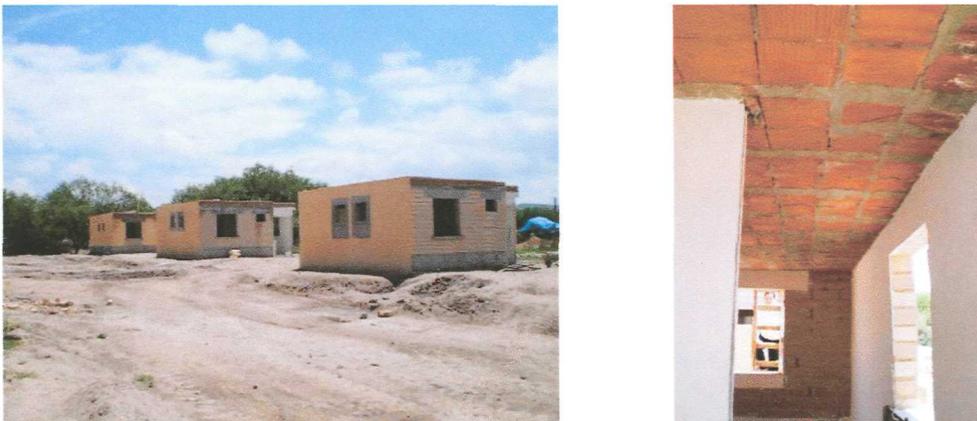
Viviendas en construcción en Doctor Arroyo, y cubierta de vigueta y bovedilla.
